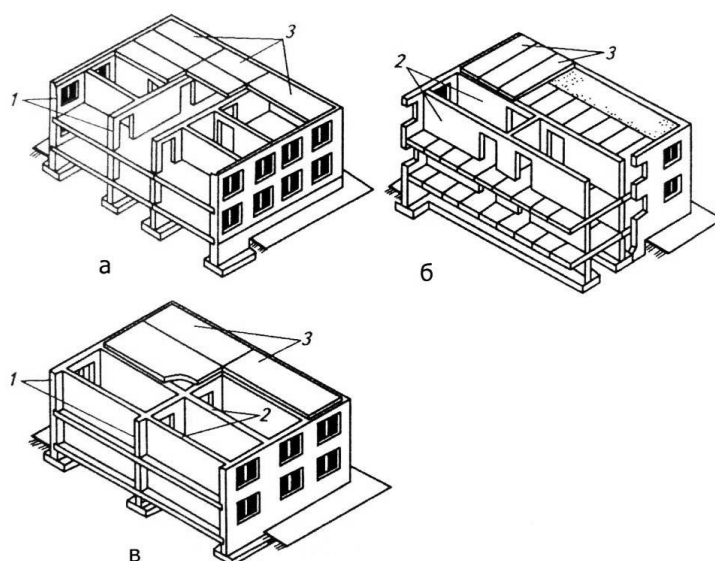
Конструктивные схемы бескаркасных зданий [79]:
